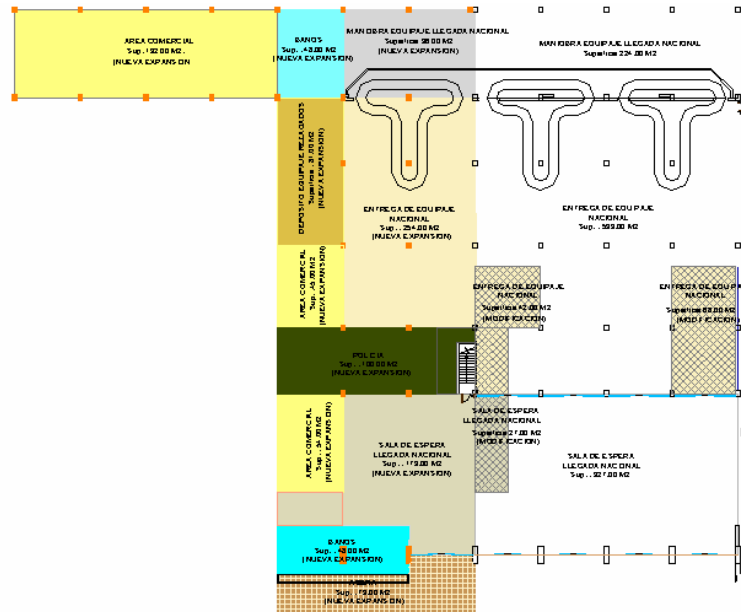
Planta Baja (Proyecto de Expansión Terminal Nacional)
